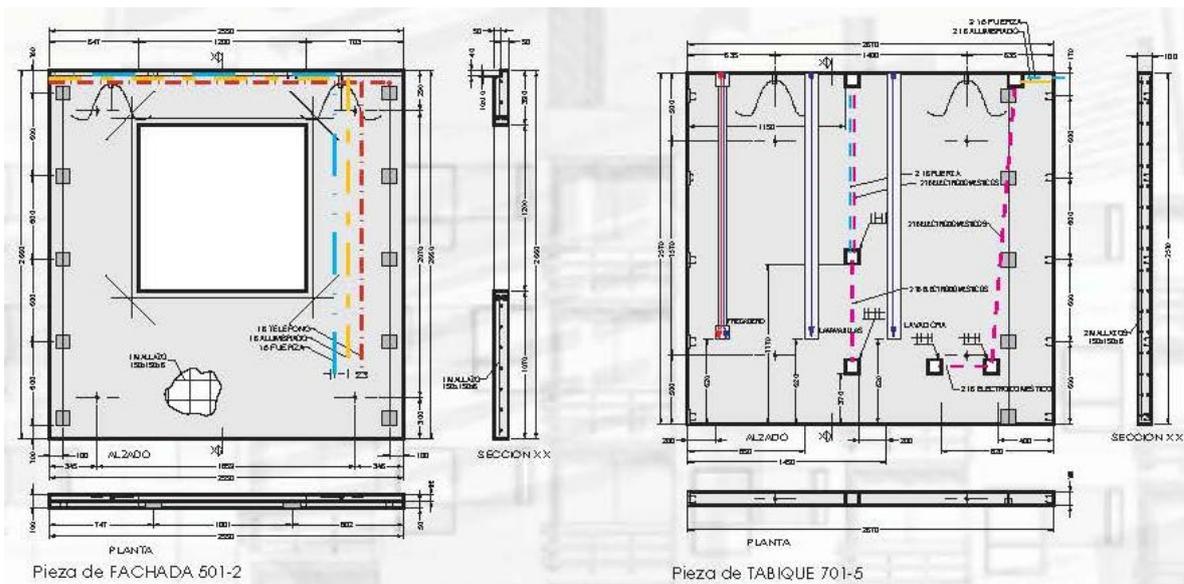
Tipo de panel de fachada BSCP. Fuente: BSCP Archivos de presentación empresarial.
